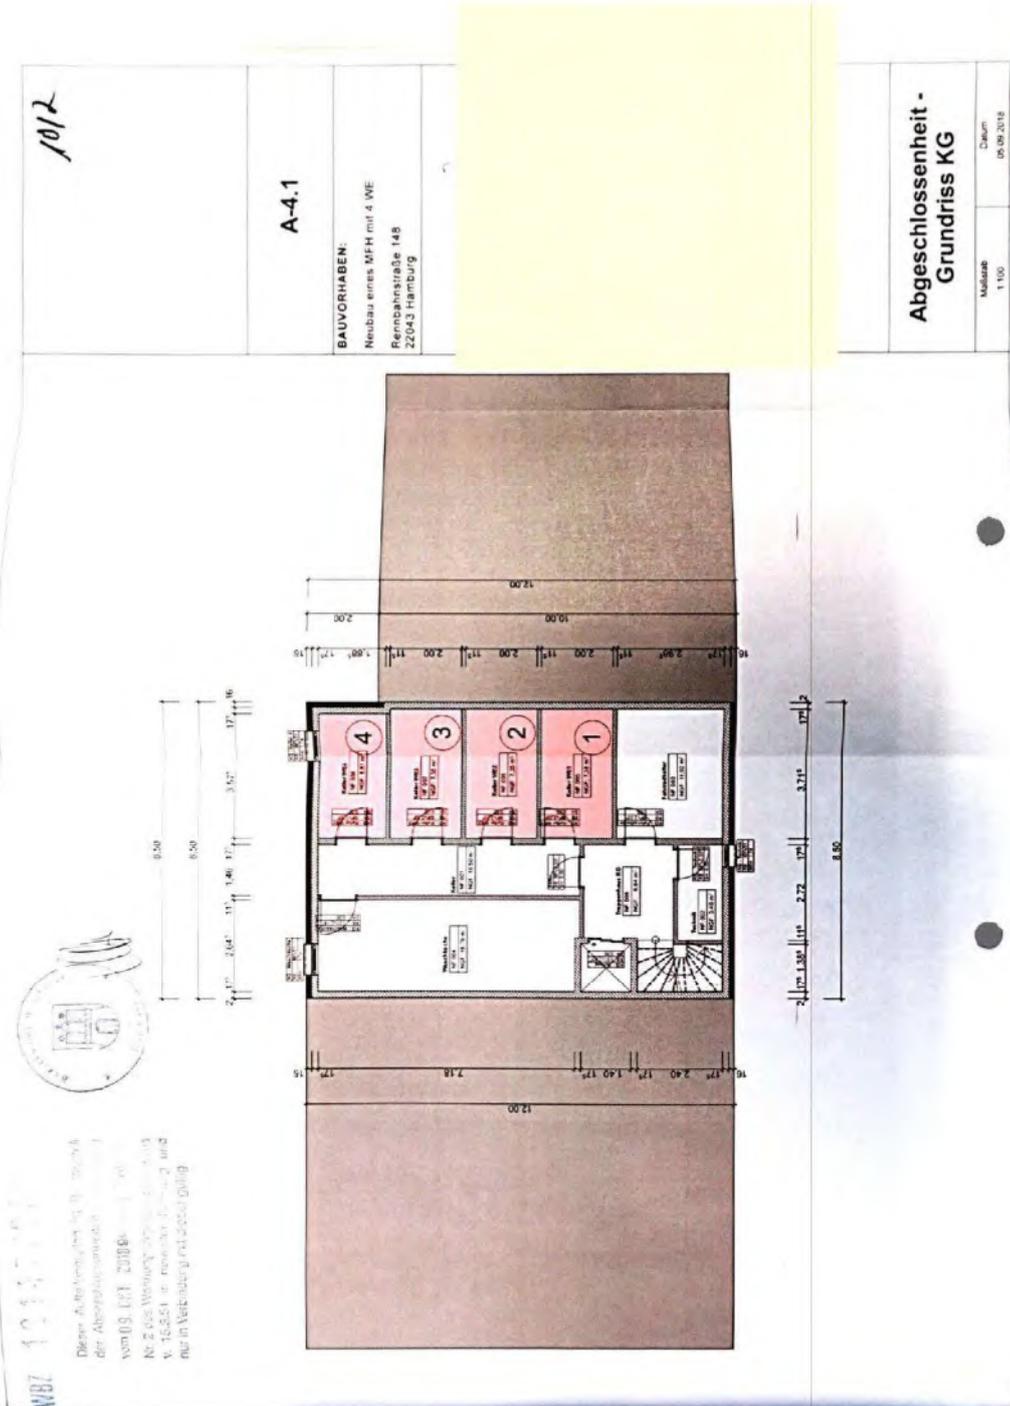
Grundriss KG Gesamtplan mit Keller Nr. 3
